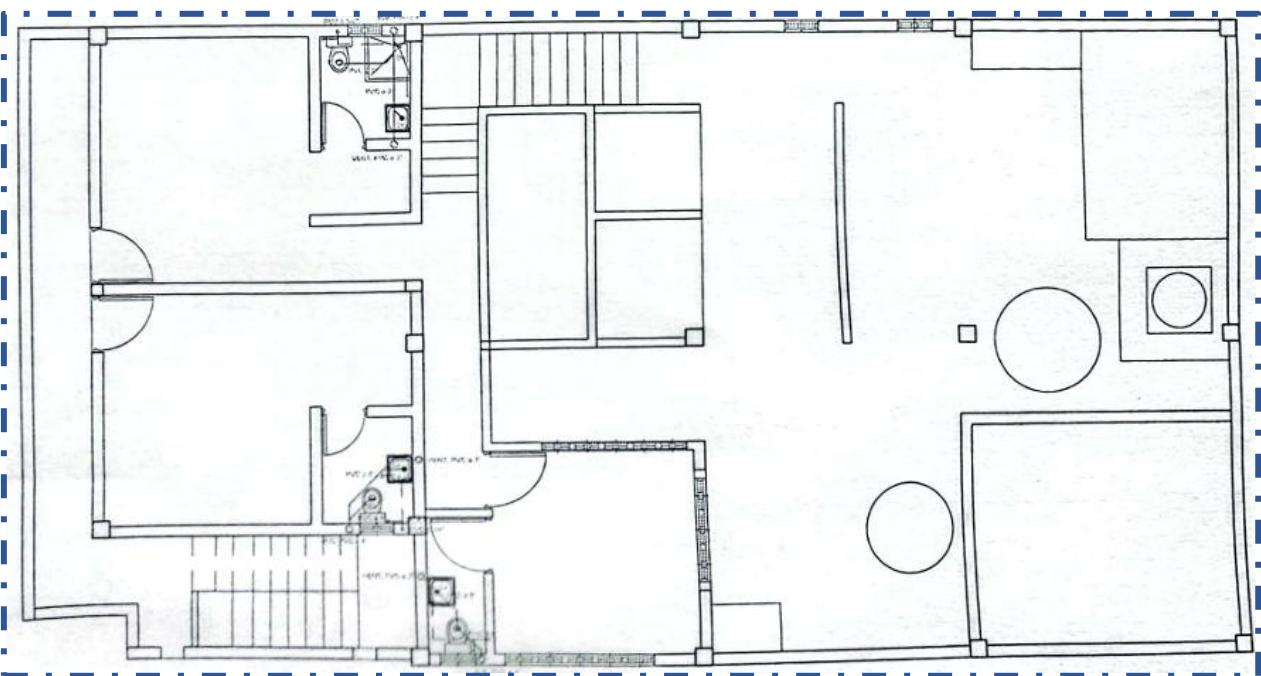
Planta Arquitectónica planta sanitaria 2do nivel.
